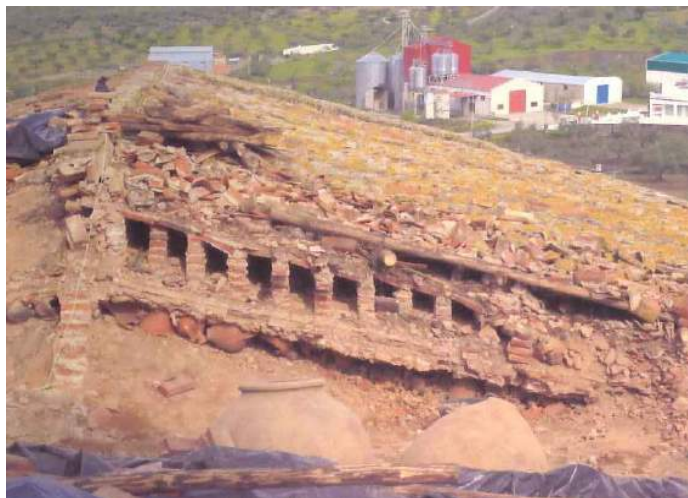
Tercer plano de apoyo del tejado sobre elementos vegetales.
